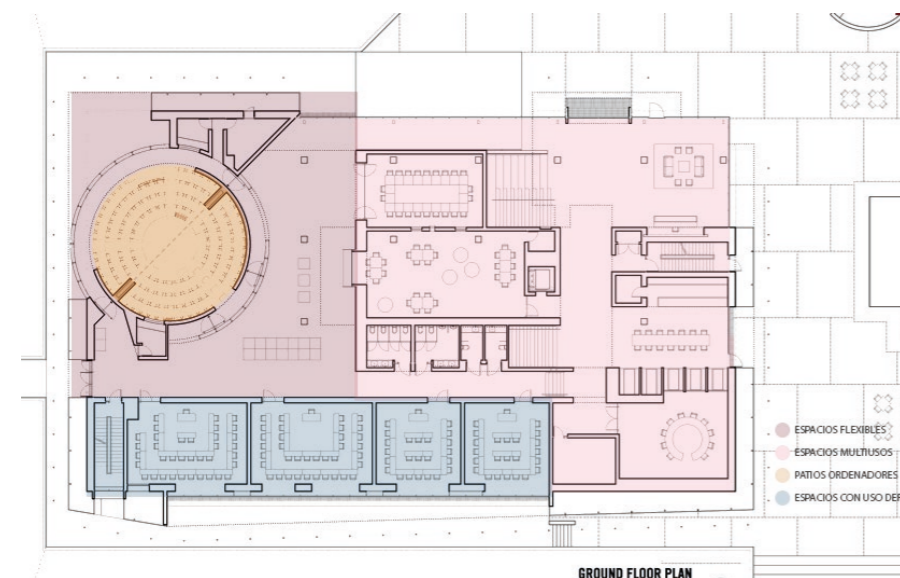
Planta baja. Adaptado de Plataforma de Arquitectura, 2015
